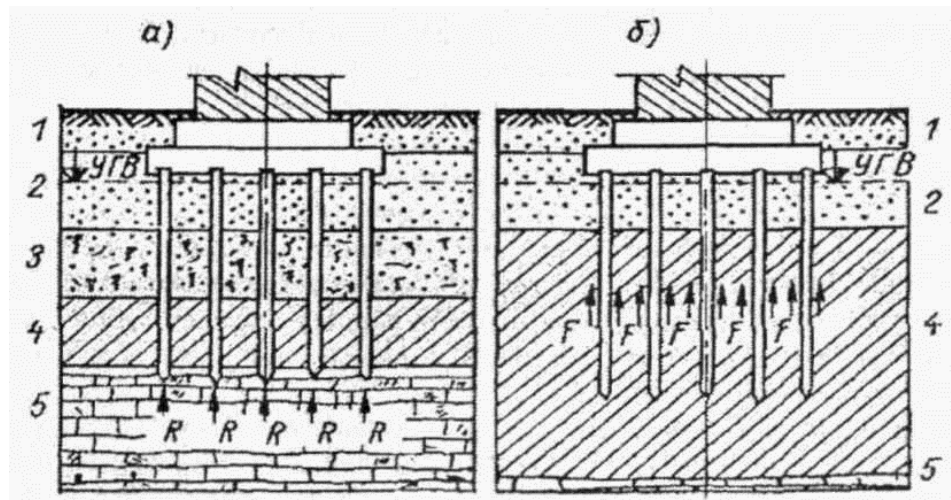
Схемы работы свай: а – сваи-стойки; б – висячие сваи; 1 – растительный грунт; 2 – водоносный песок; 3 – торф; 4 – слабый суглинок; 5 – скала; R – сопротивление грунта; F – сила трения между боковой поверхностью свай и грунтом
